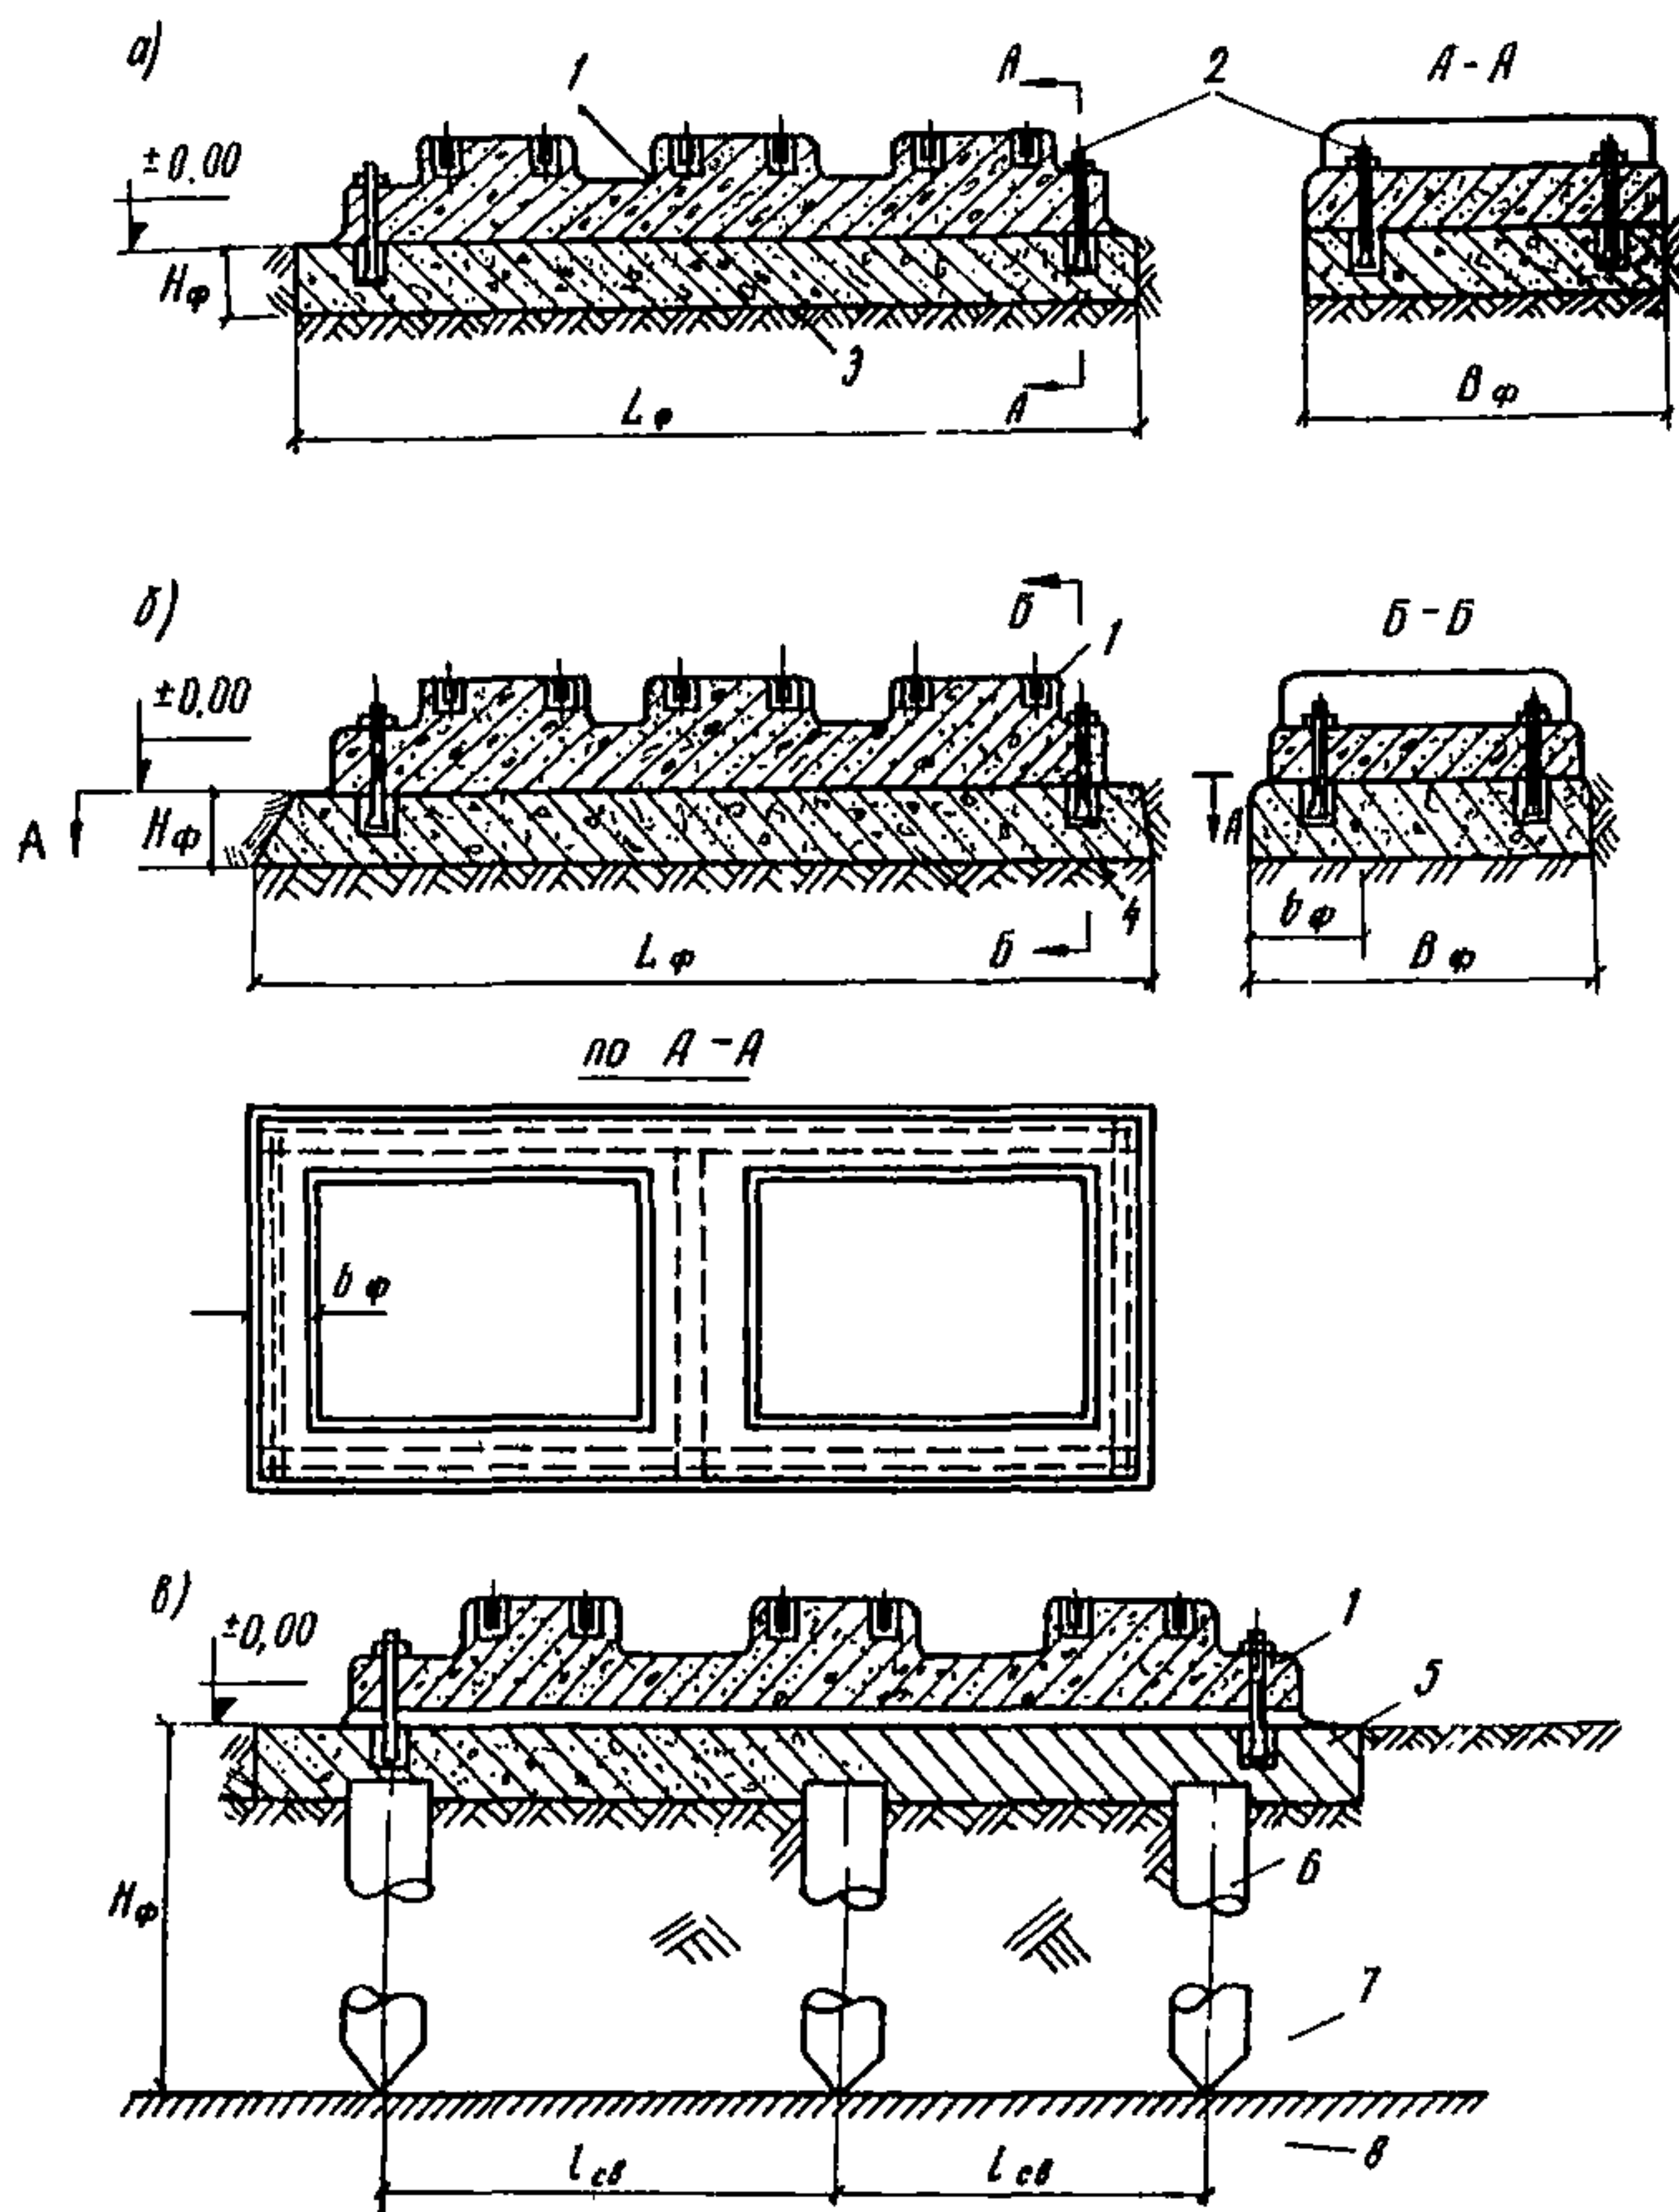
Типы фундаментов под крупные блоки оборудования на отметке ± 0.00 :
